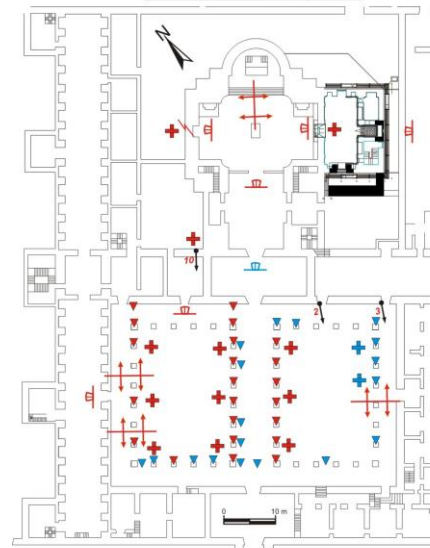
Planta del Hospital de Tavera y EAAs. Los EAAs en azul corresponden a la primera planta y en rojo los de la segunda planta.
